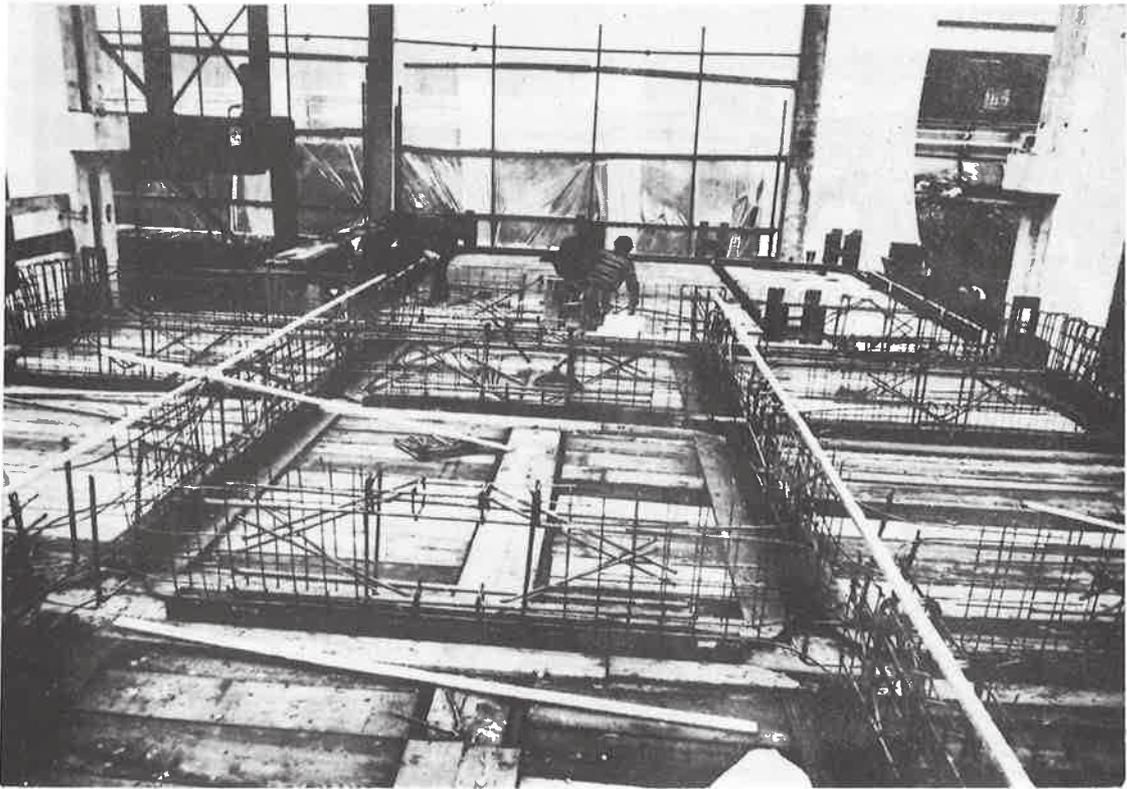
prefabbricazione armatura con rete e barre attorno ai fori nervature
